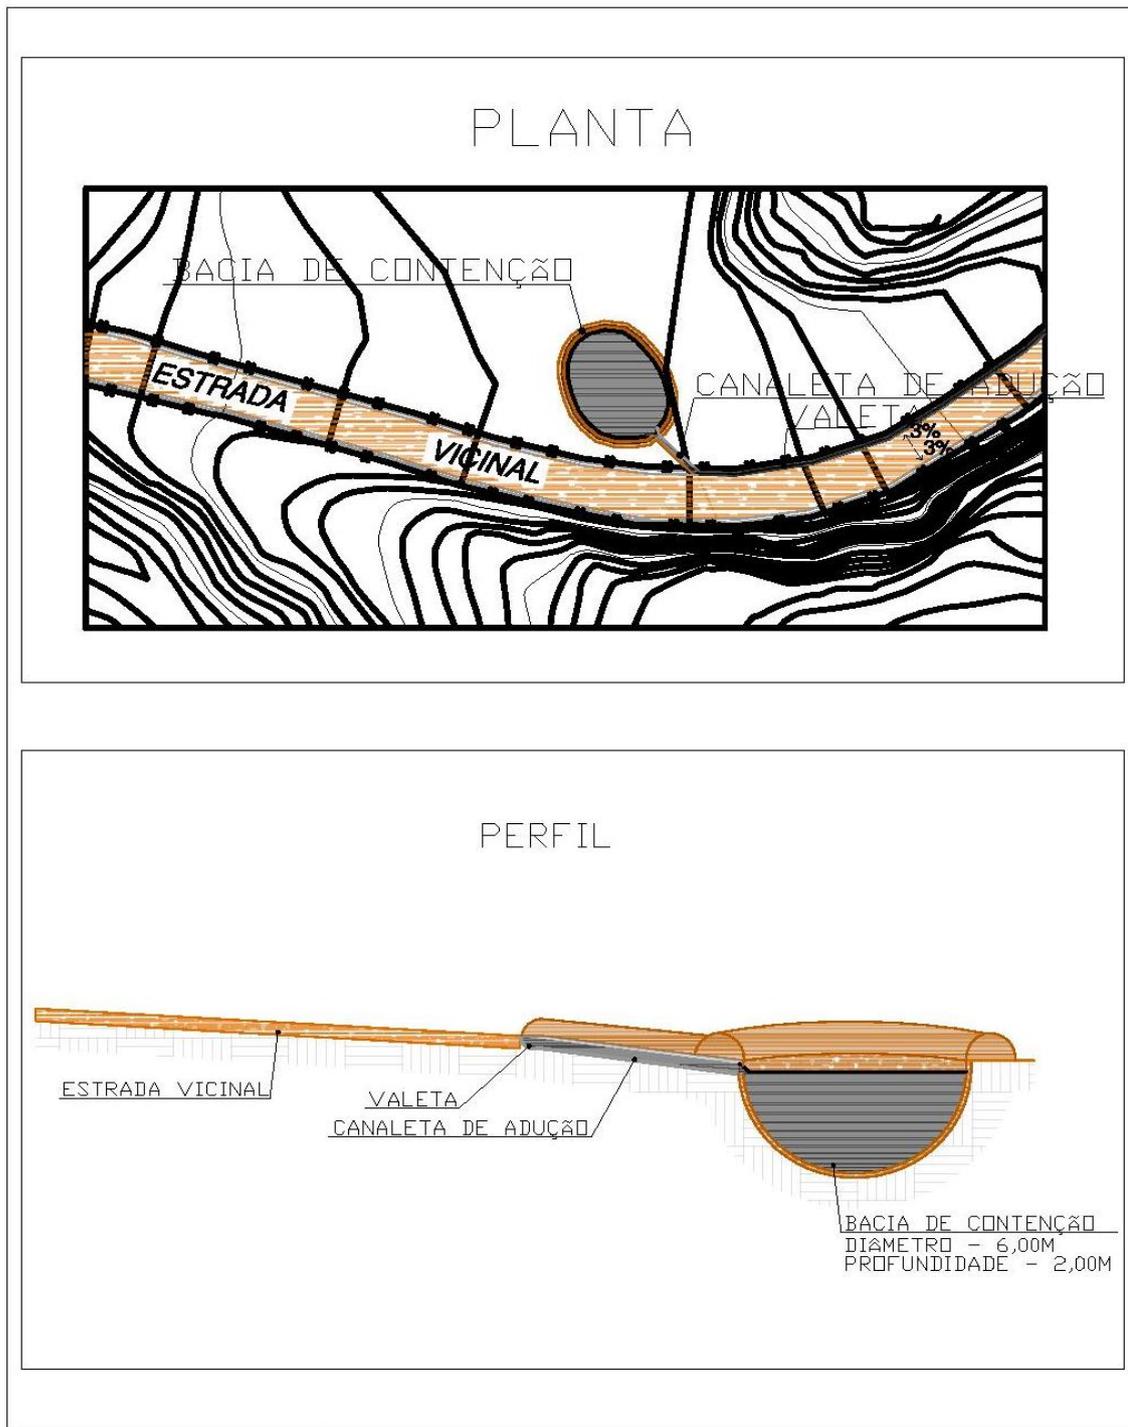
Planta e perfil de bacia de contenção de águas pluviais
